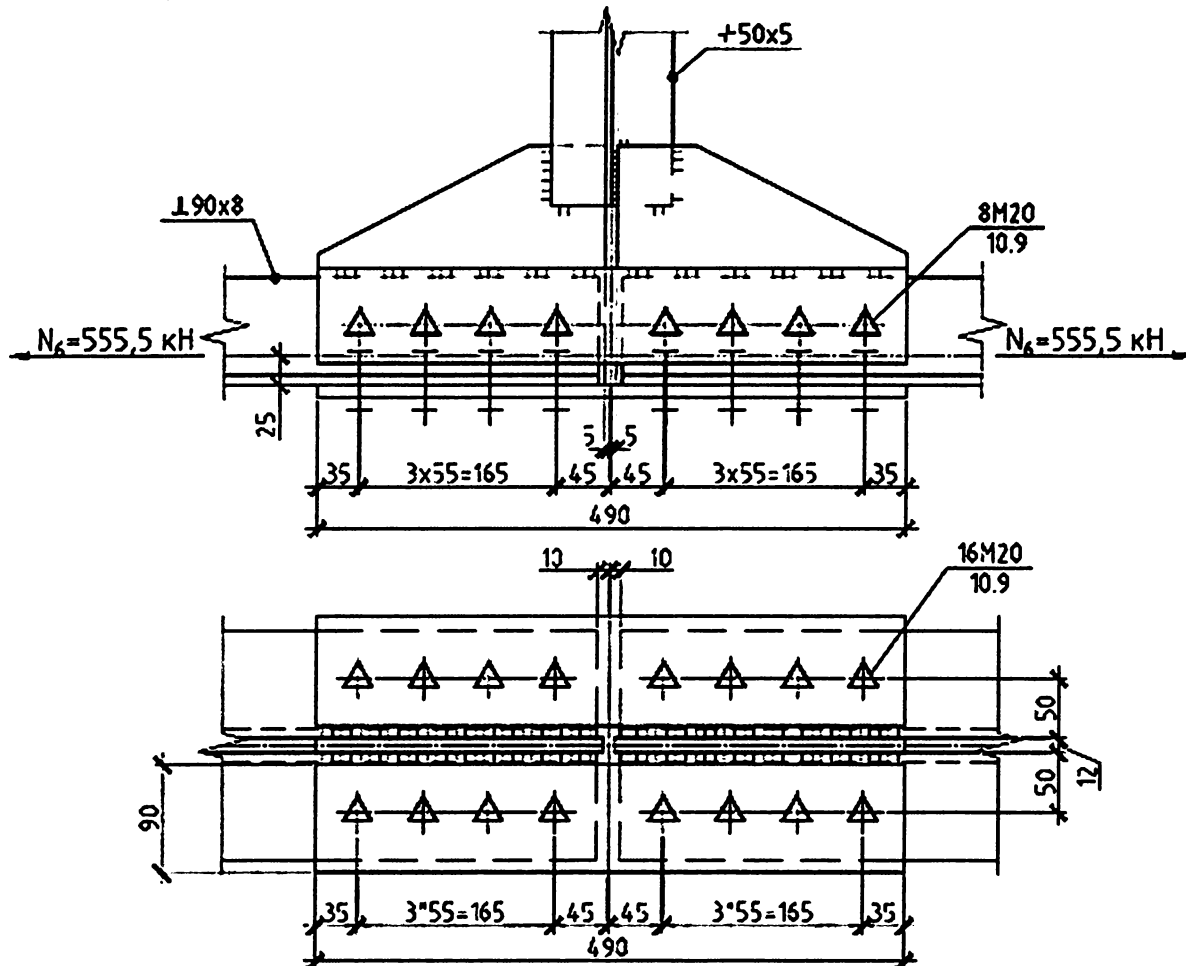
Монтажный узел нижнего пояса фермы
